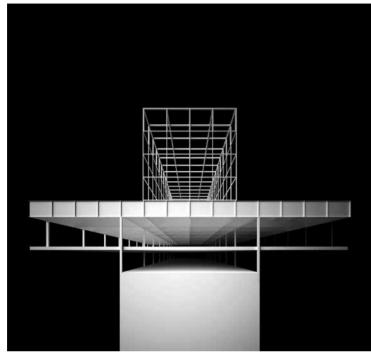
CONCEPTO ESTRUCTURAL. NUEVA SEDE PARA LA EMPRESA VITEOS S.A., LA CHAUX-DE-FONDS (SUIZA). PROYECTO EN CURSO, 2021-2026. FUENTE: GNWA
